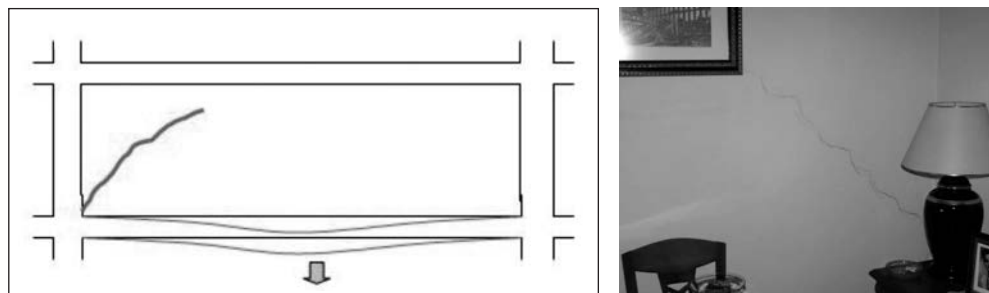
Fisuras producidas por deformabilidad de viga soporte
